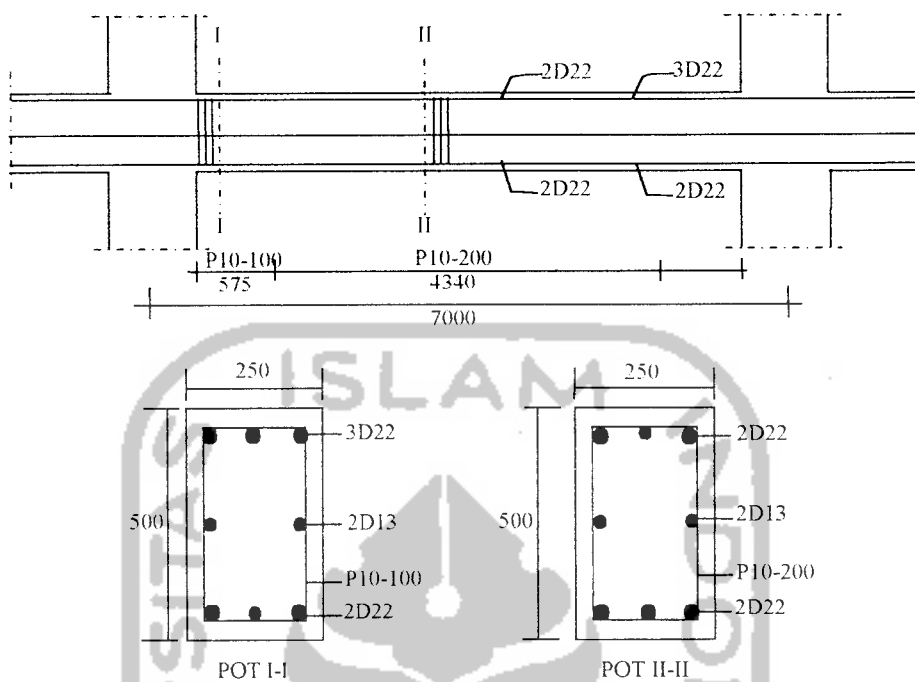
Balok Portal E Bentang 7m Lantai 10
